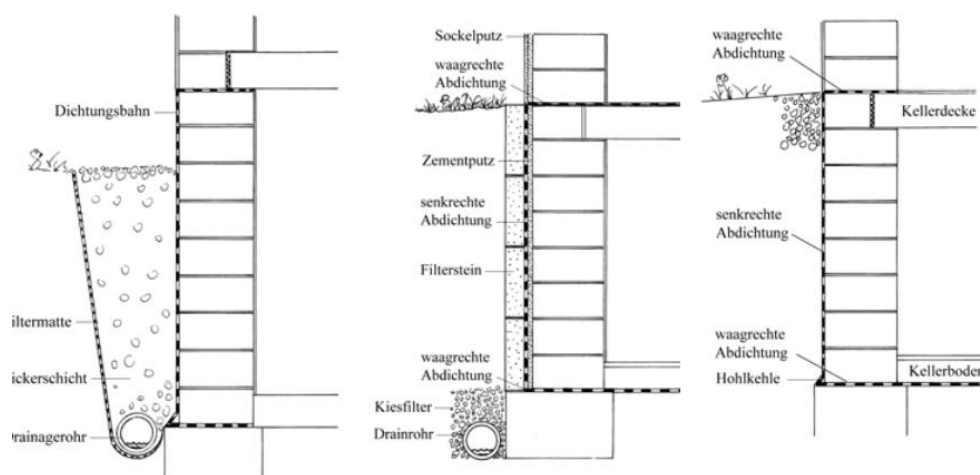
Exemplo de impermeabilização de fundações (Nachwachsende, n.d.)
